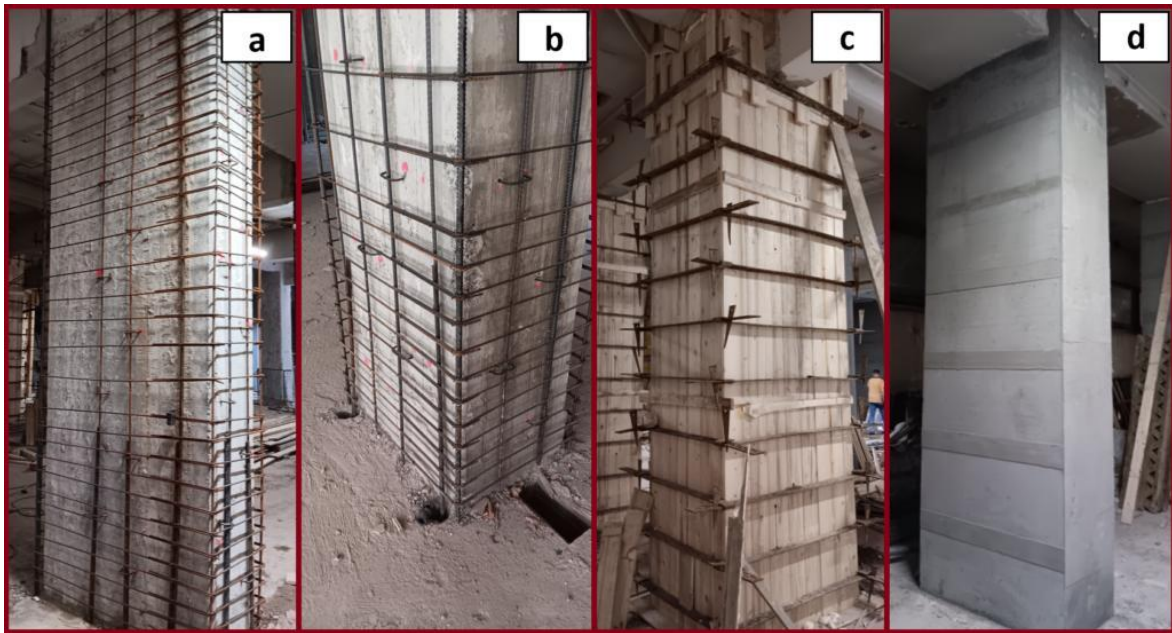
Étapes de chemisage en béton armé d'un poteau centré
